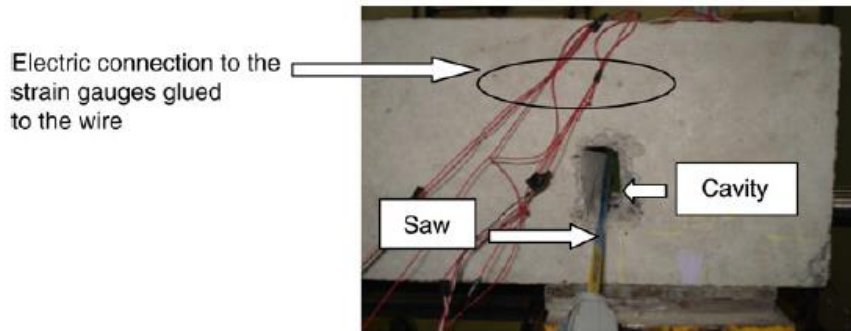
Forma de las cavidades (cavity) en las vigas y de la manera de corte (saw) de los cables [1]
